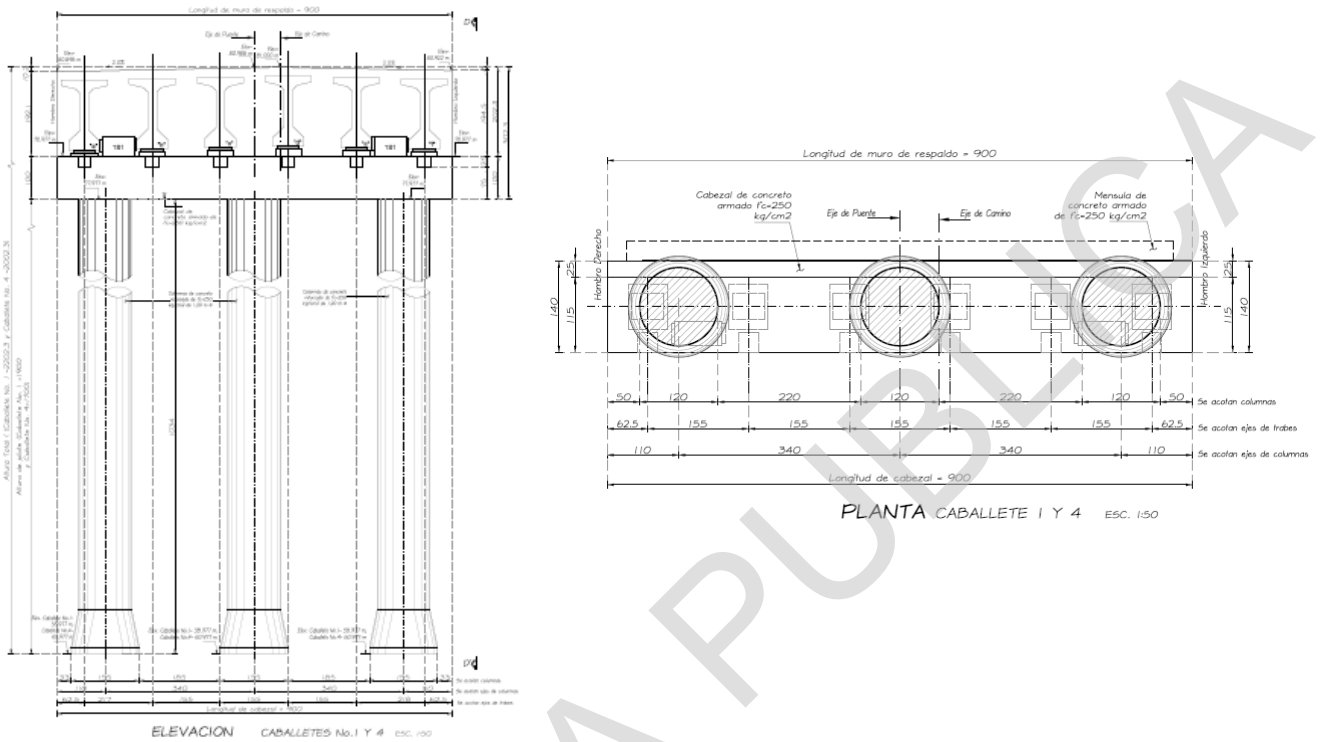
Planta, elevación del caballete 1 y 4 (pilote).
